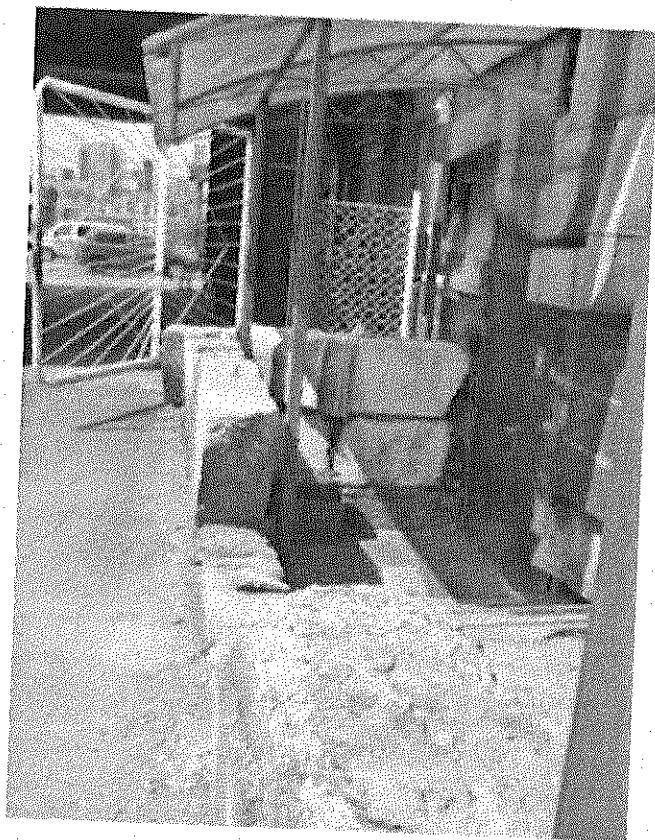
Фасад здания в осях А/7-9. Отметкой пола помещений ниже планировочной отметки земли на 450мм. Первый этаж здания.
